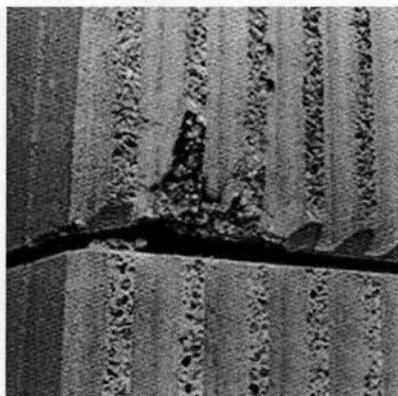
Fisura causada por el manejo y/o fijación incorrecta de paneles prefabricados.
